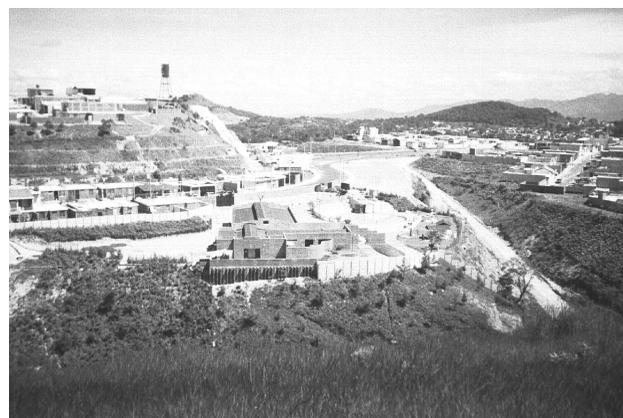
COLINDANCIA CON EL CEMENTERIO
